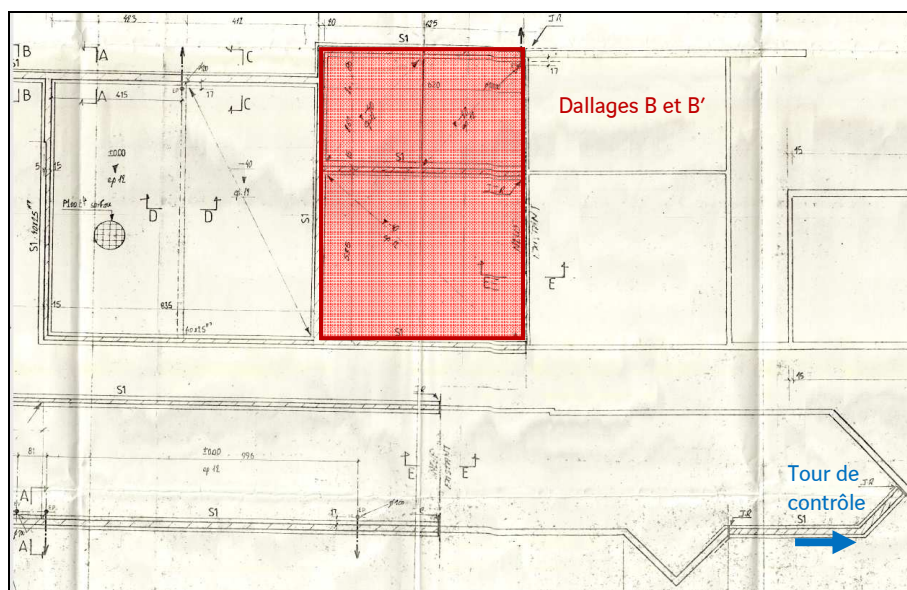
Vue en plan des dallages B et B' – Extrait Plan Fondations extensions A et B – Exécution – 20/12/94
